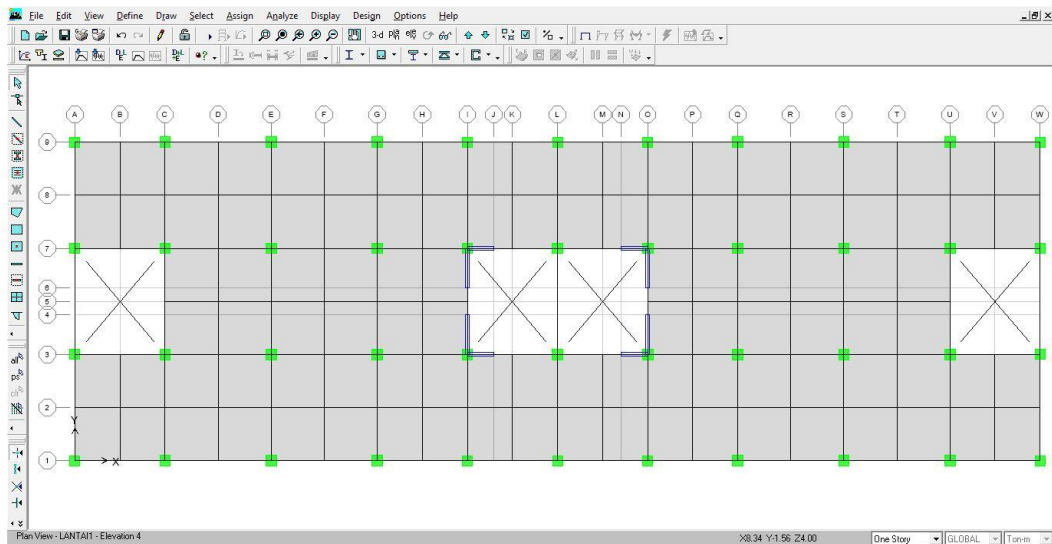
Denah Tampak Samping Arah y Struktur *Shearwall* Model 2
